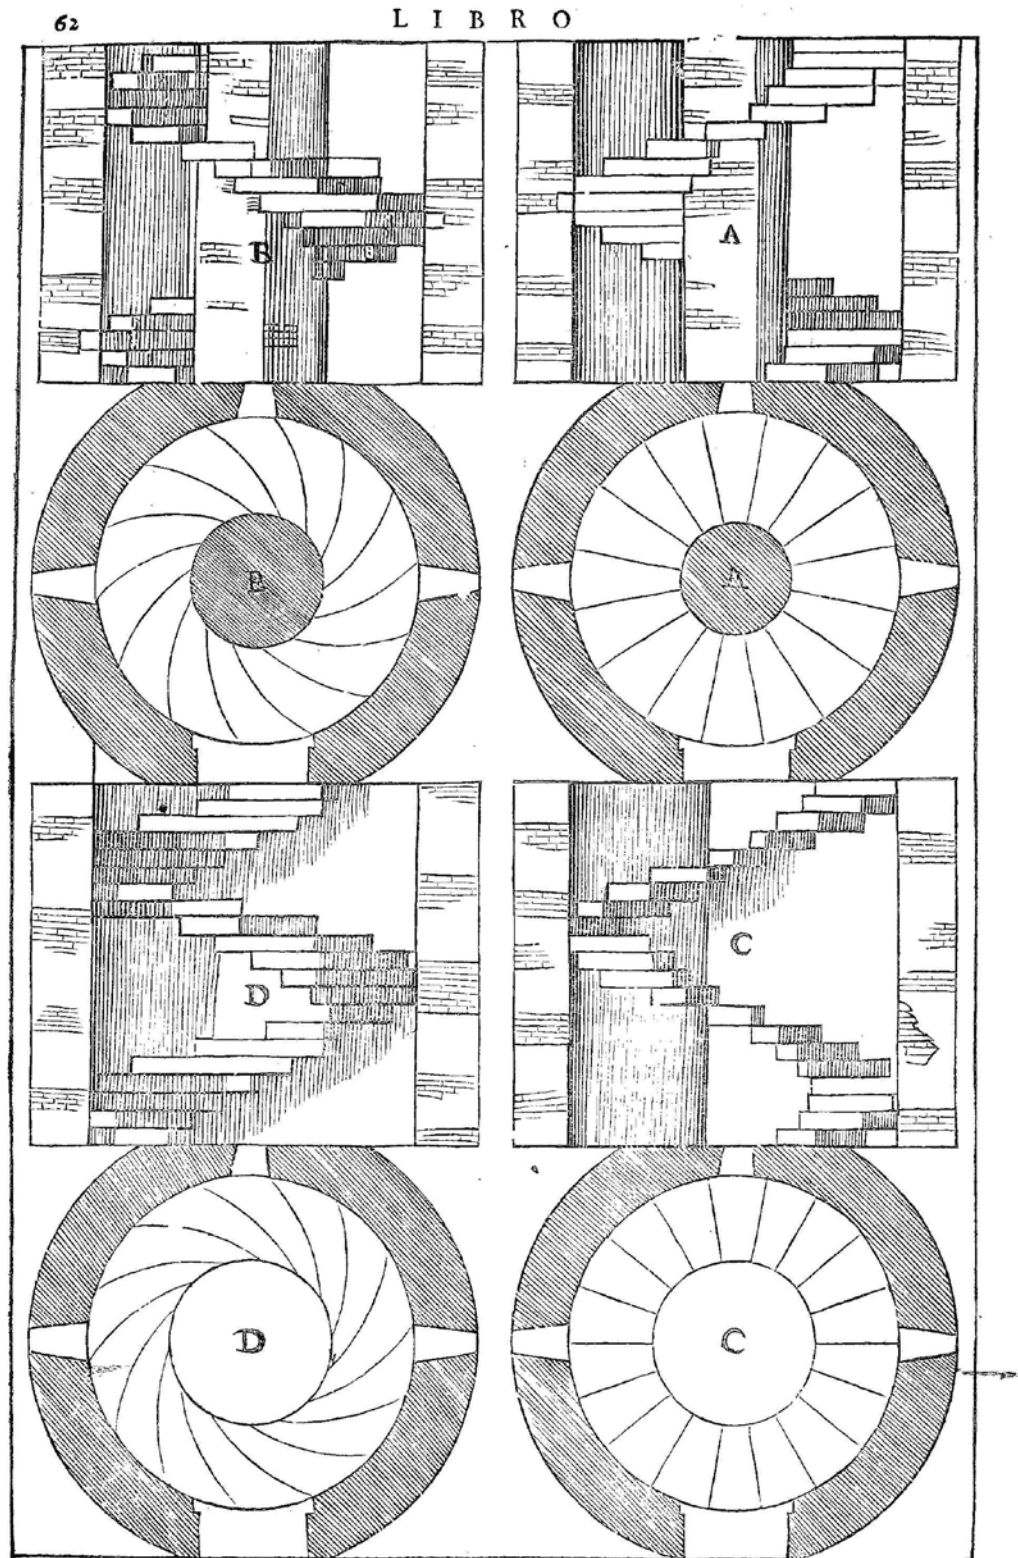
Escaleras de planta circular con y sin núcleo. Fuente: Palladio (1570).
